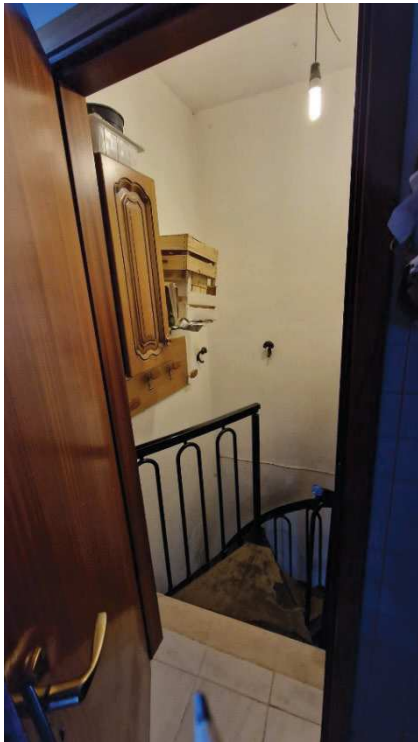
Accesso alla scala di collegamento tra piano terra e S1
